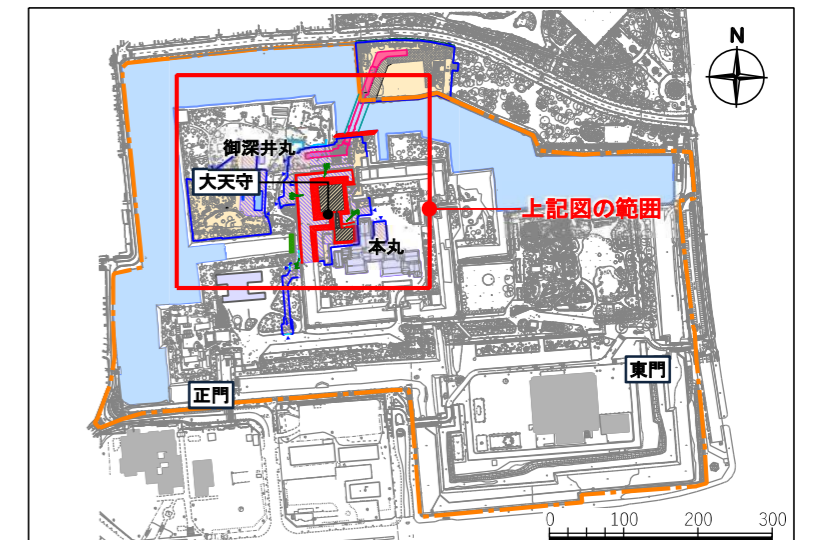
石垣の保存及び安全対策工事時の平面図(敷地全体)
